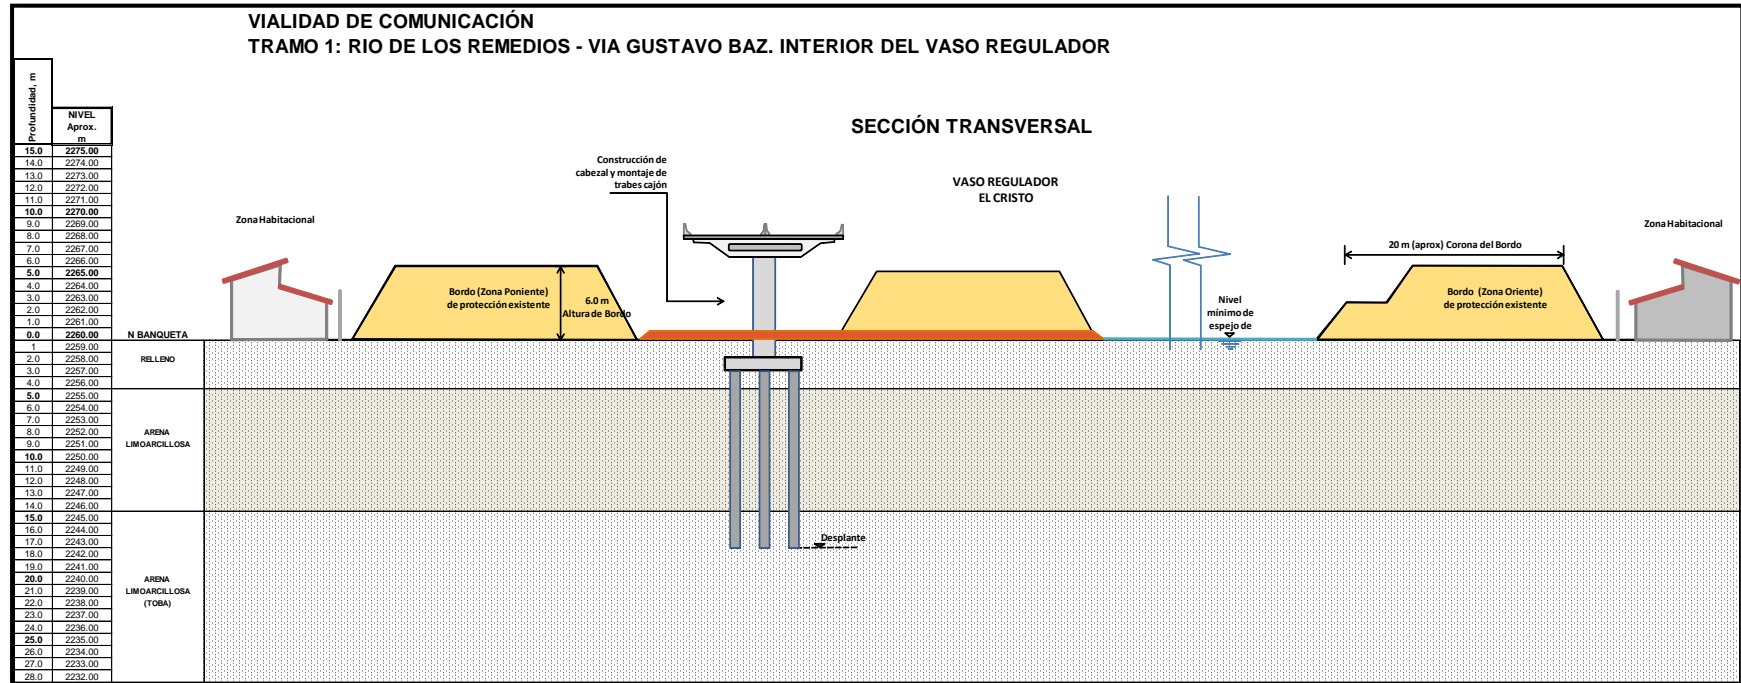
En la siguiente imagen se observa que una vez concluidos los trabajos de colado in situ de las pilas y de la zapata-cabezal, se comenzará con el montaje de piezas prefabricadas o construcción de las columnas, sobre las cuales una vez colocadas las traveses que van entre columnas se construirán las losas, parapetos y la preparación de la carpeta asfáltica, sobre la cual circularán los vehículos.
